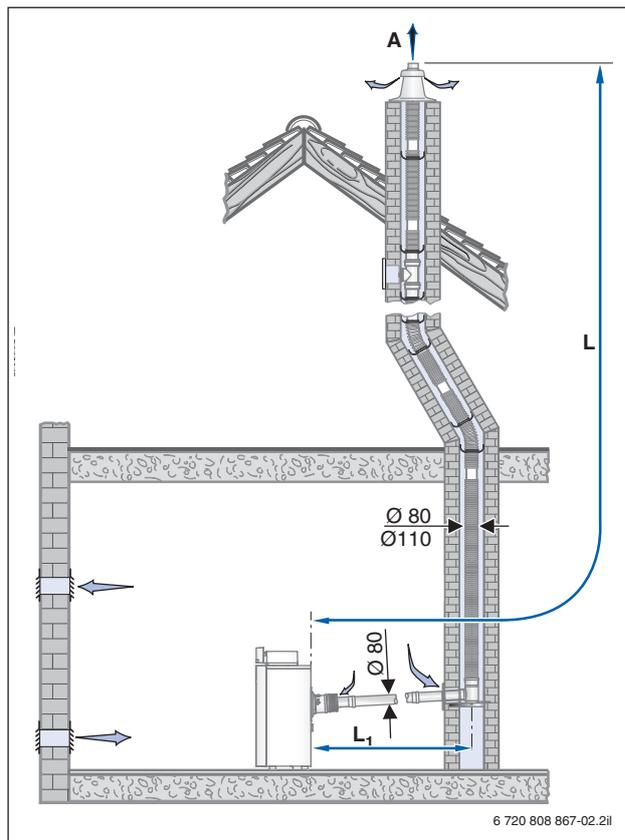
Montagevariante mit dem Bausatz GA + ÜB-flex
